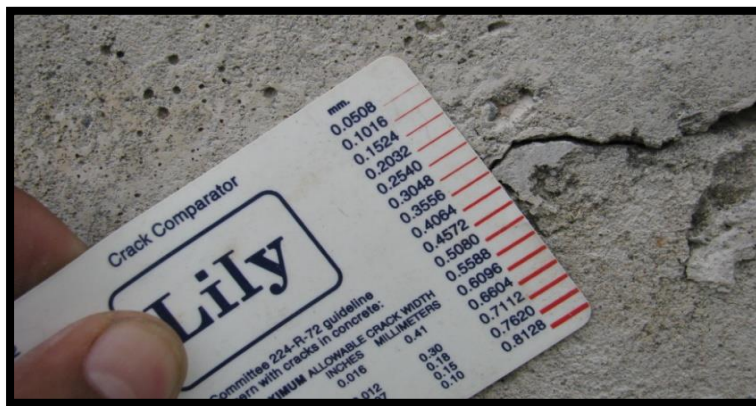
Fotografía detalle de medición de ancho de fisura en el muro del costado sur (Fuente: el autor).
